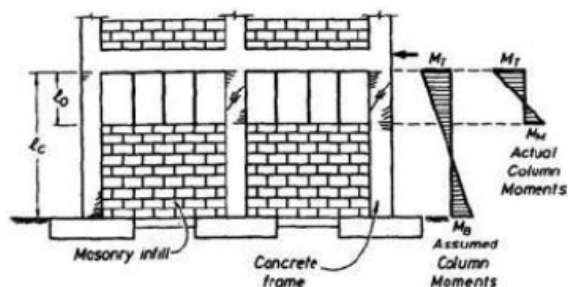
Pórtico de Betão Armado parcialmente preenchido por alvenaria [22]
